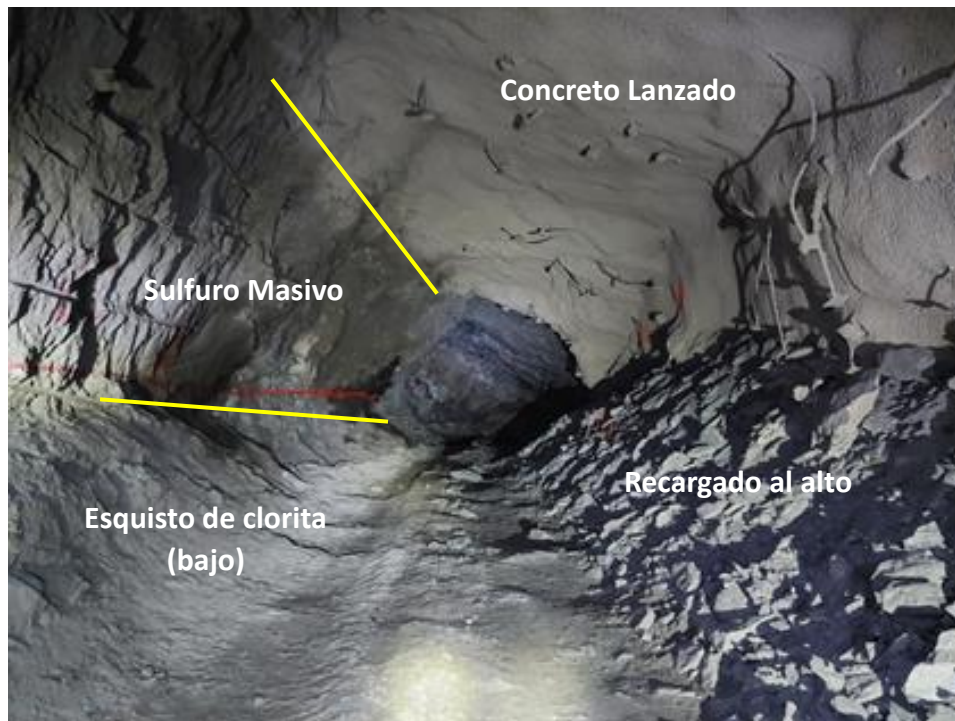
Rebaje explotado con el sistema de corte y relleno ascendente con recargado y concreto lanzado al alto. Imagen Propia.
